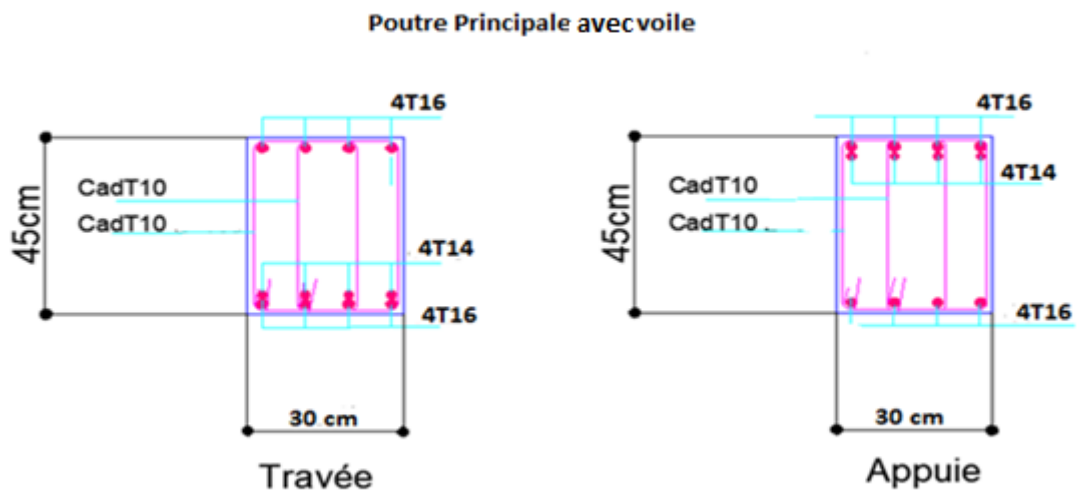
Schéma de ferrailage De la poutre principale avec voile.
